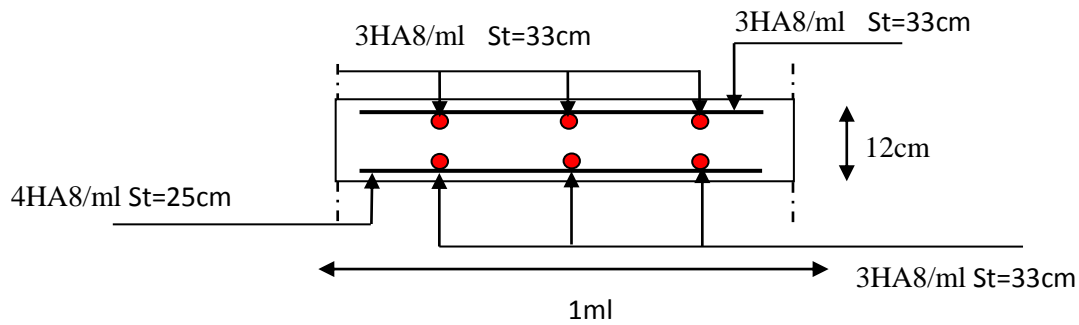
Schéma de ferrailage de la dalle pleine type N° 4.
